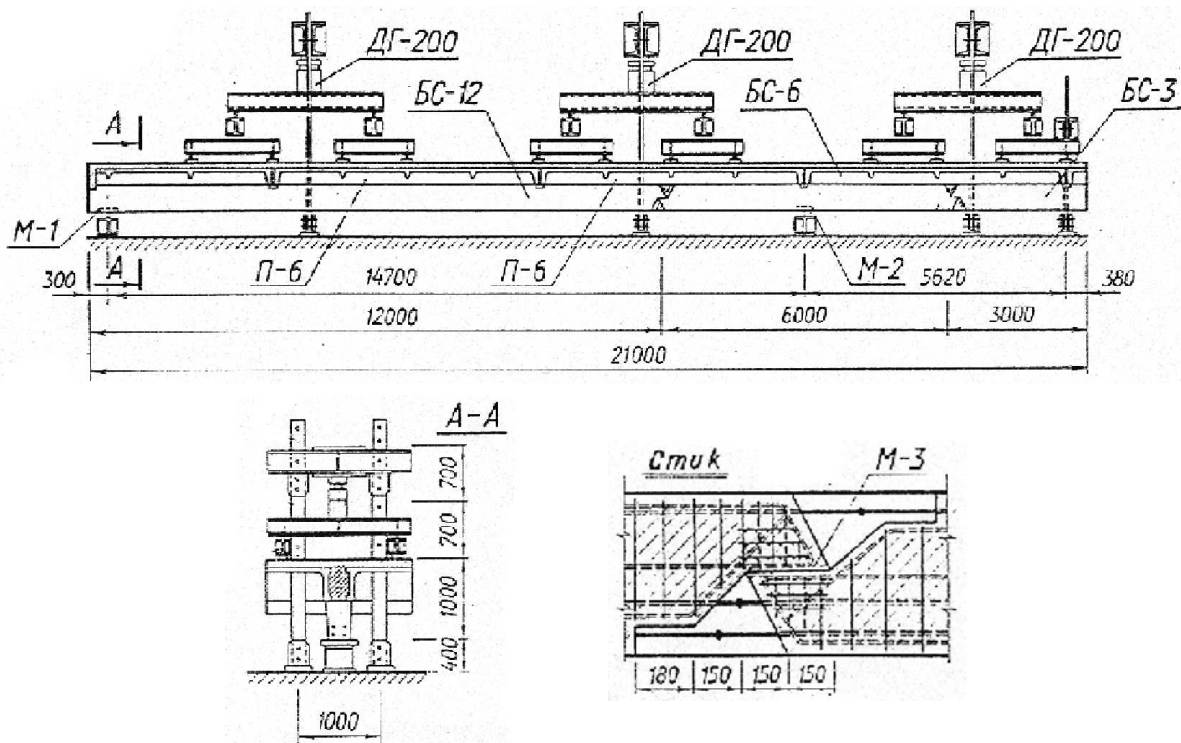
Схема випробування фрагмента збірно-монолітного прогону нерозрізного моста
